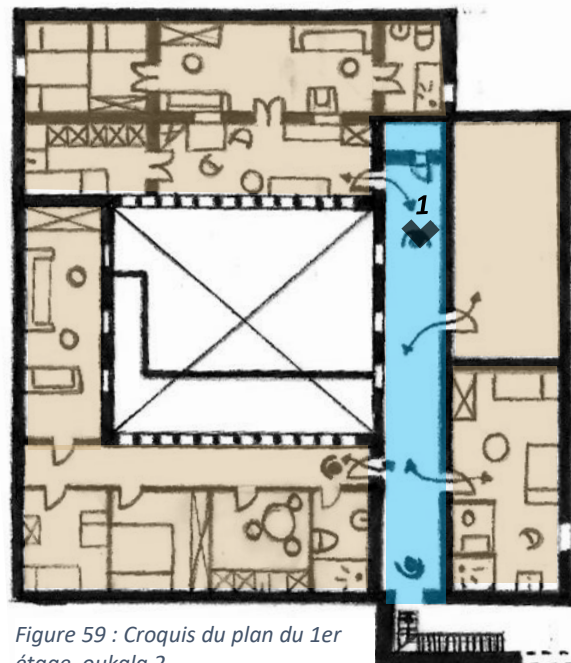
Croquis du plan du 1^{er} étage, oukala 2
